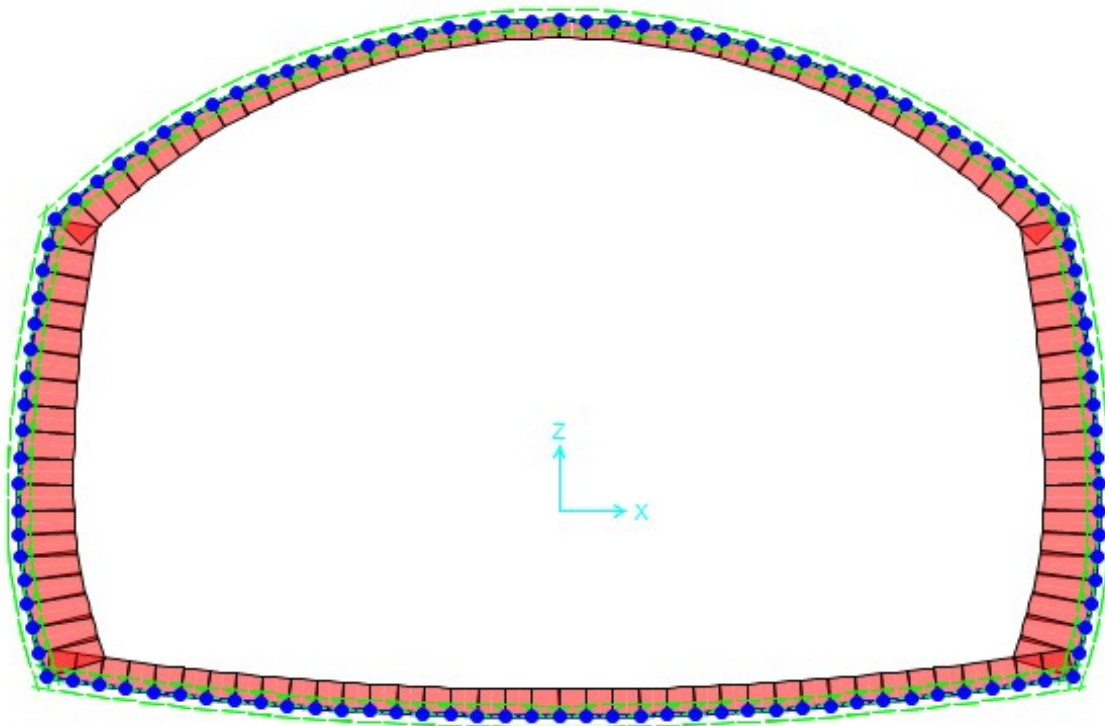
Sezione GA-C2-Imb - Andamento dell'azione assale nella combinazione SLE.
